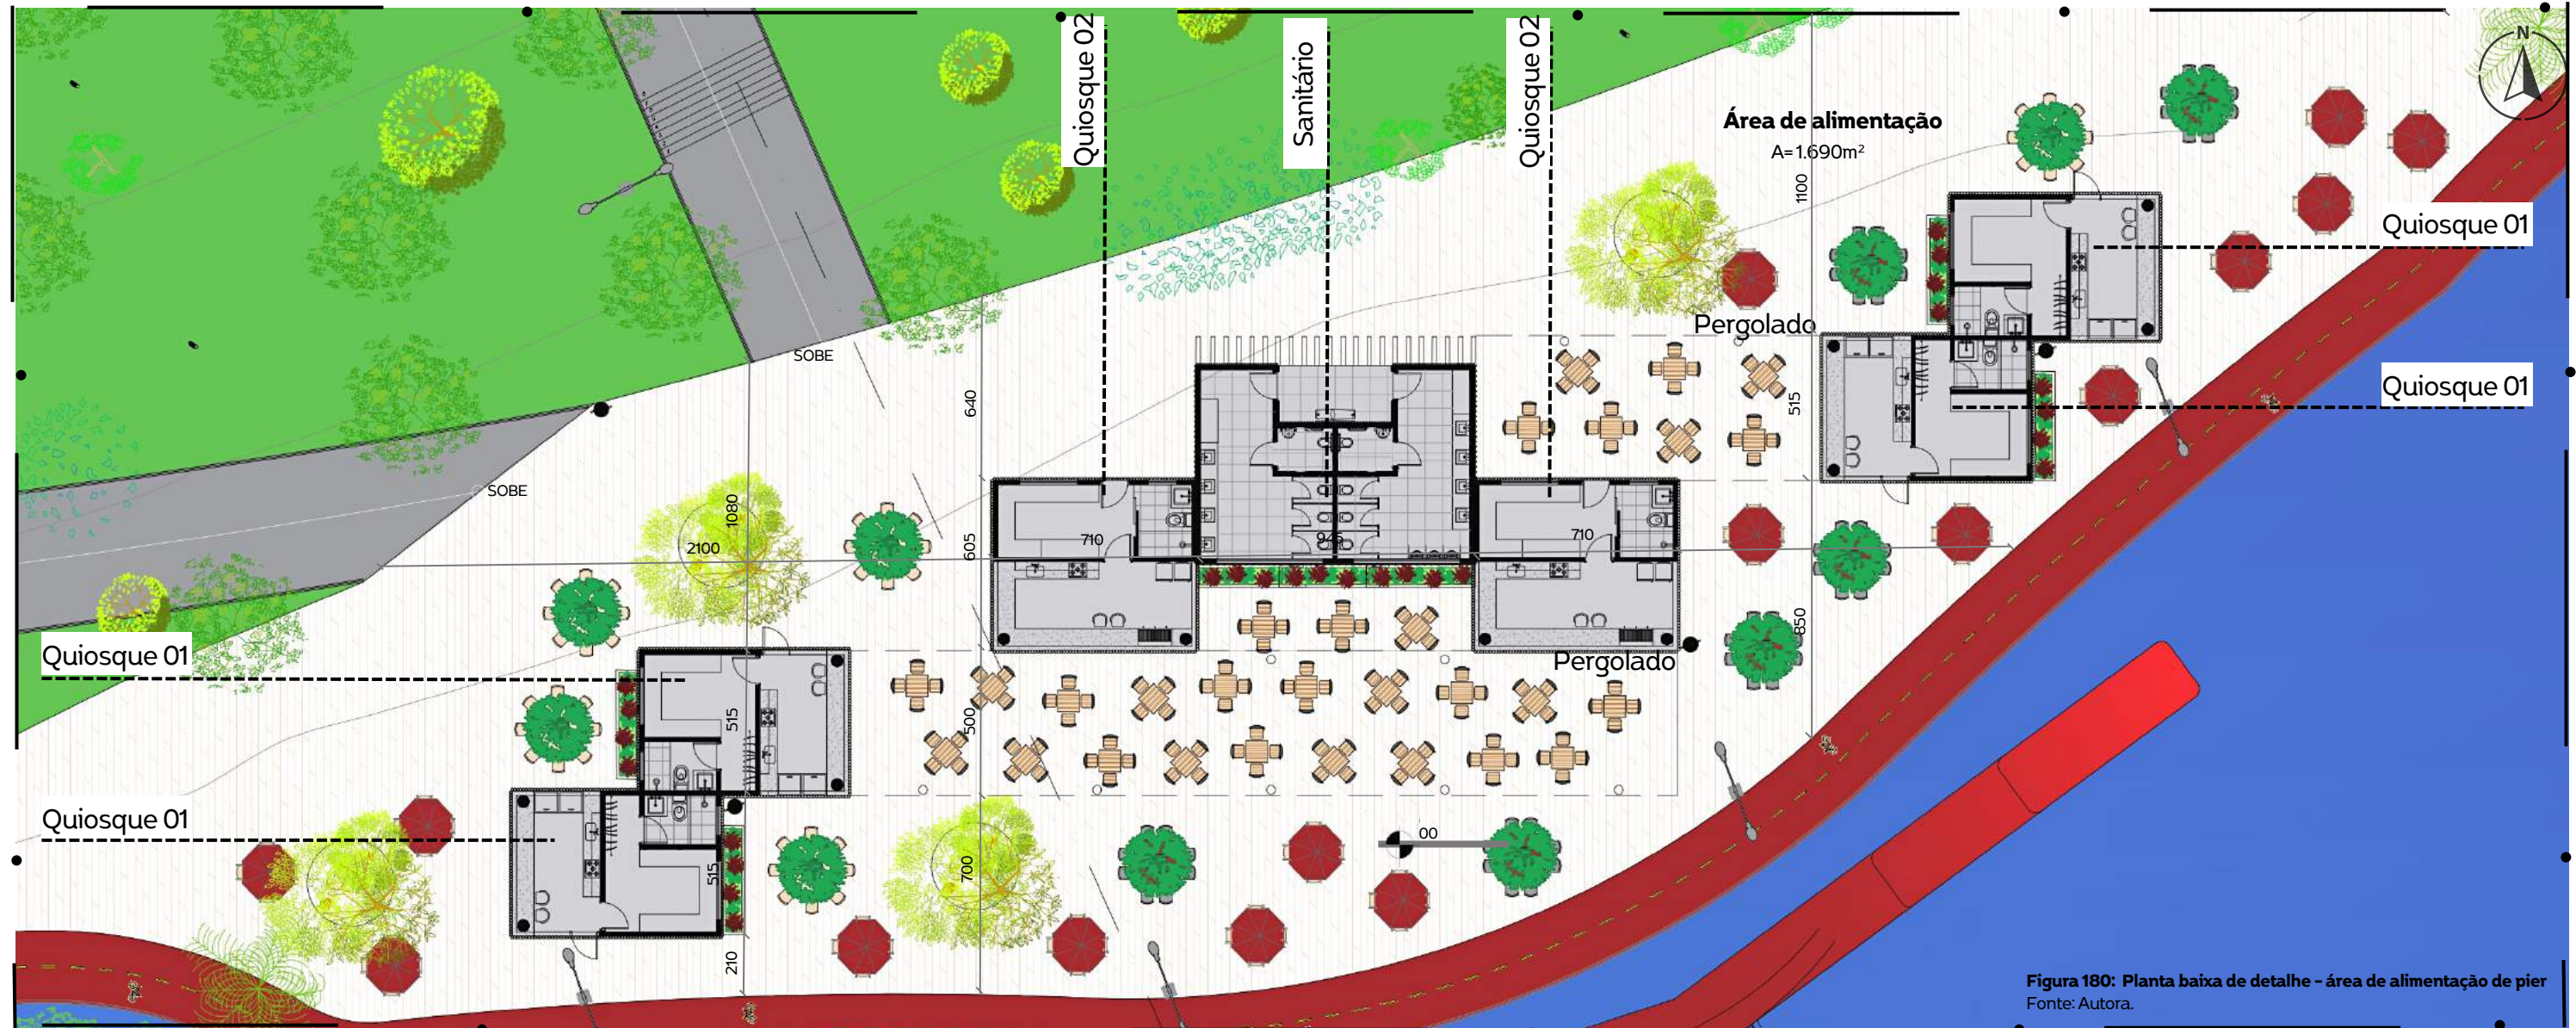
Planta baixa de detalhe - área de alimentação de pier
